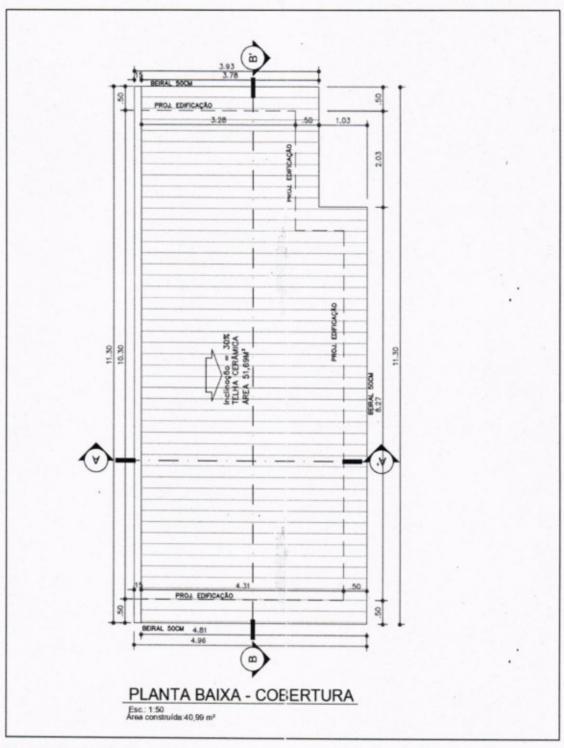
Planta Baixa – modelo 01 Fonte: o próprio autor
